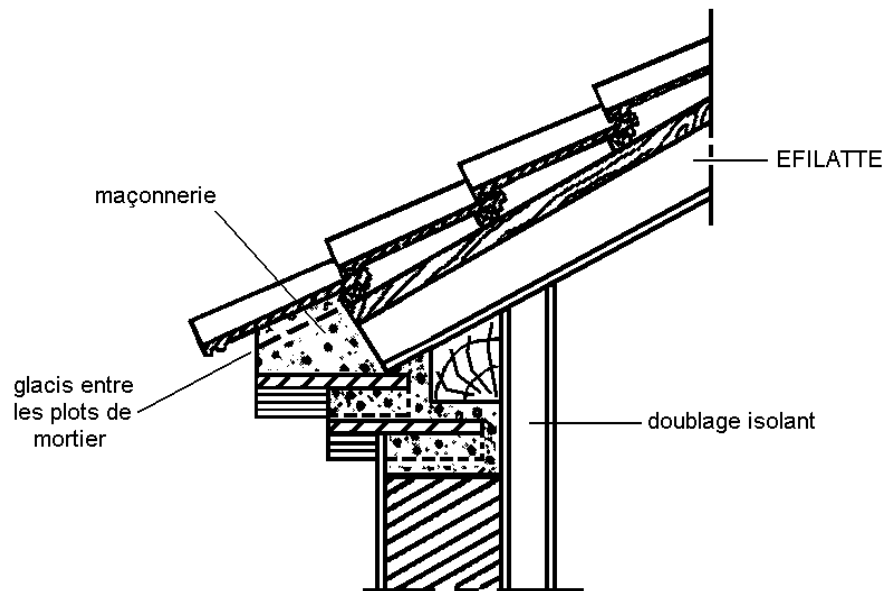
Finition en rive d'égout - Caisson en butée sur genoise
